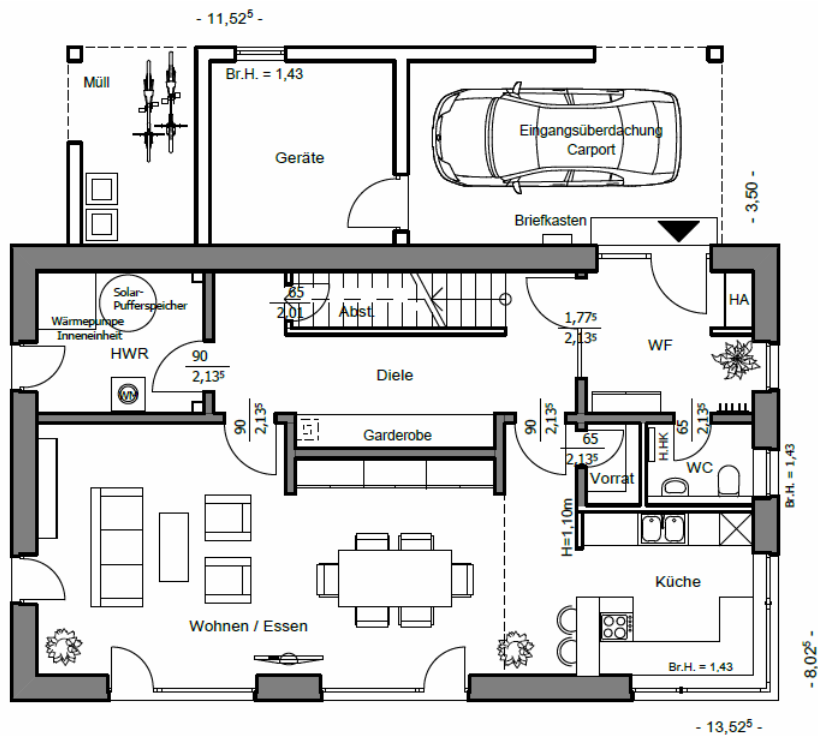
Grundriss EG des Konzepthauses
